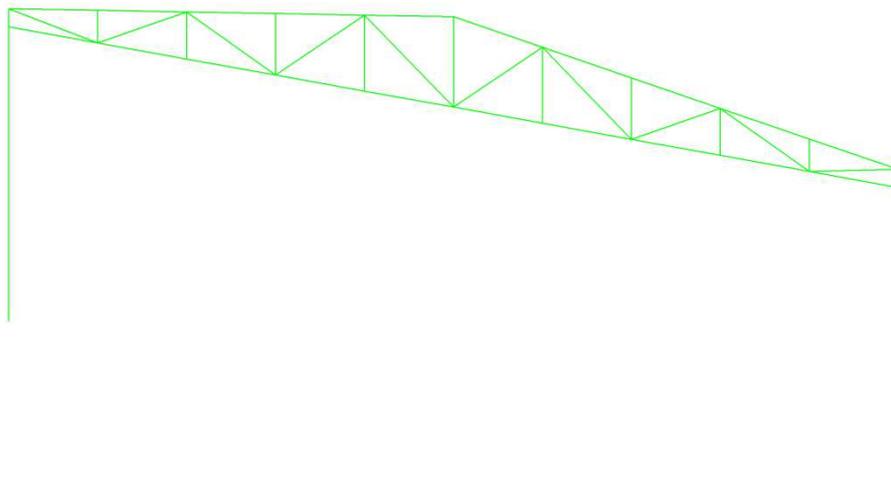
Действие нагрузки от собственного веса фермы
